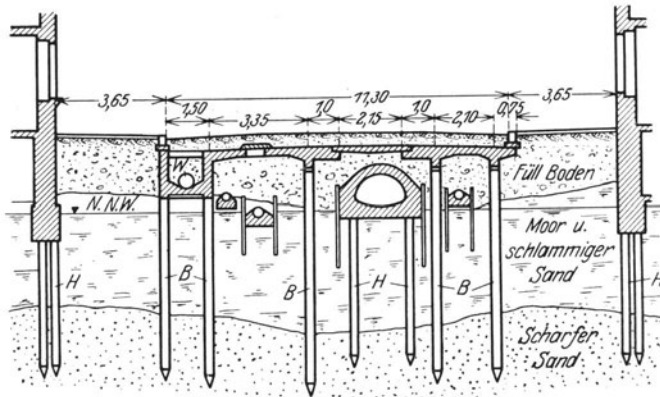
Gründung der Siemensstraße in Oberschöne-weide-Berlin auf Mastpfählen. (Nach O. Colberg: Handbuch für Eisenbetonbau.)
